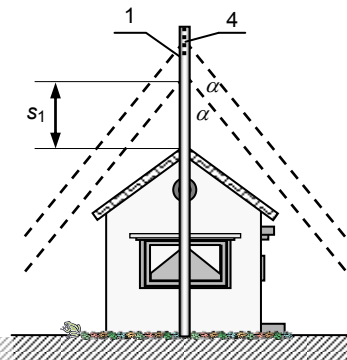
Projection sur un plan vertical perpendiculaire au plan contenant les deux mâts
